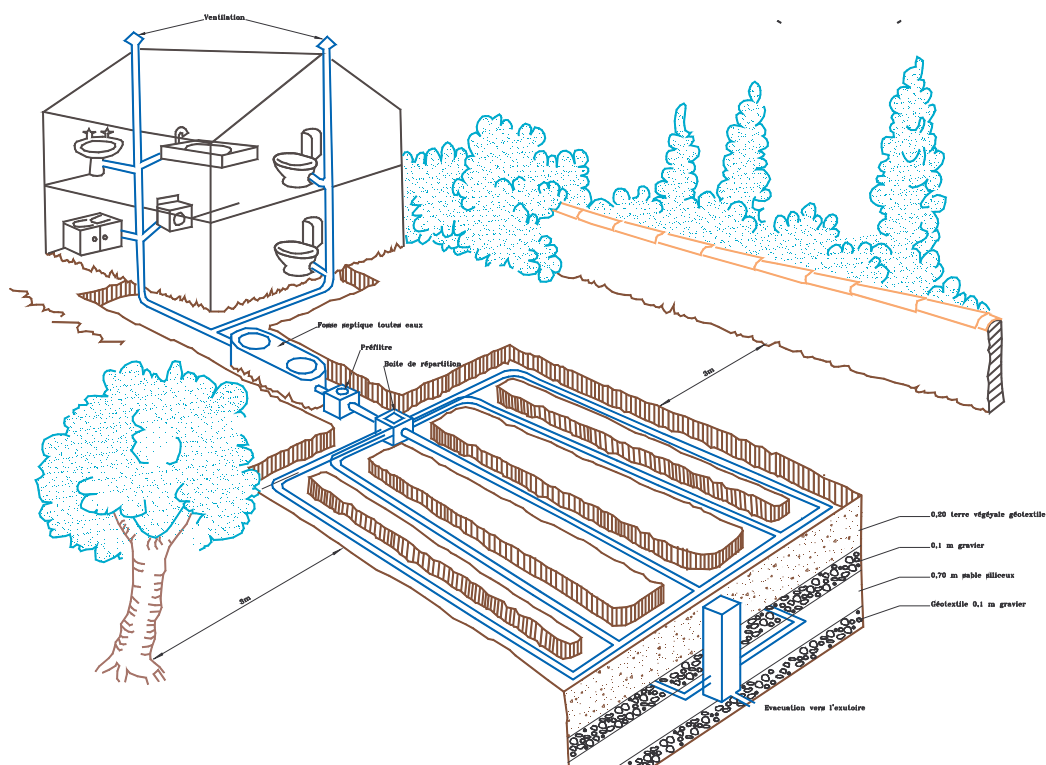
b : exemple d'une filière d'assainissement non collectif avec filtre vertical drainé
